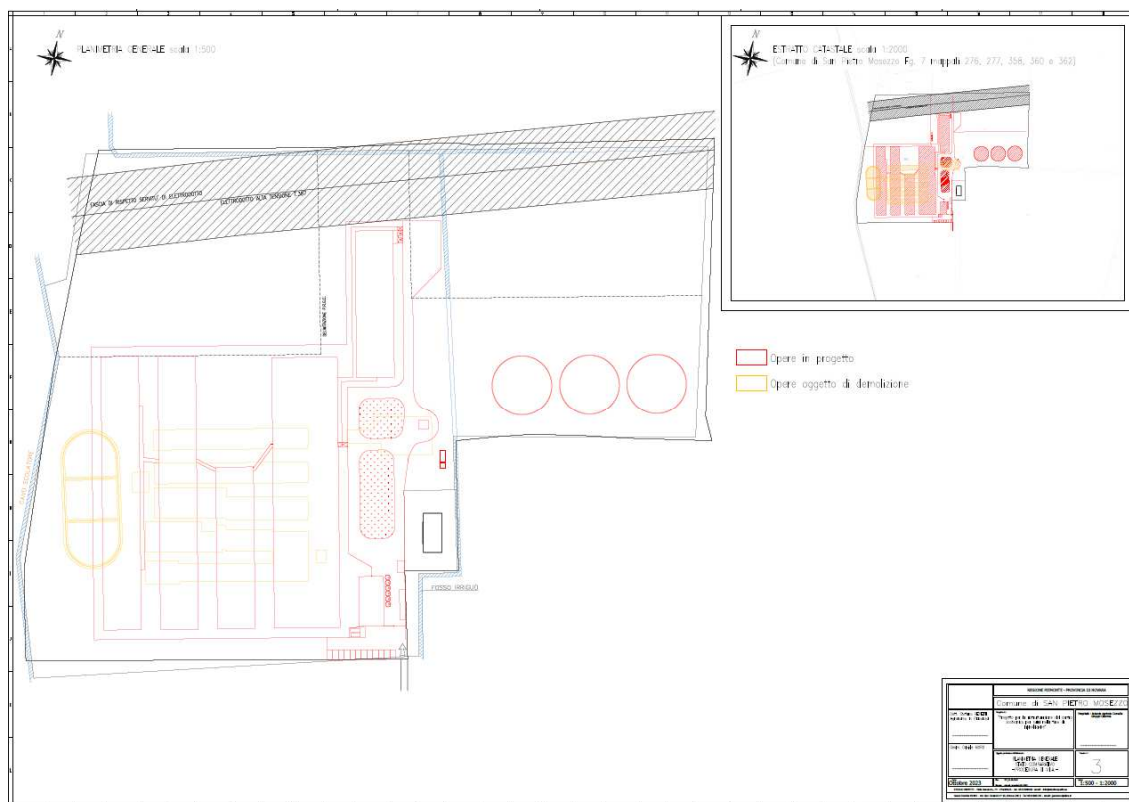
Planimetria generale stato comparativo (Tavola 3)
